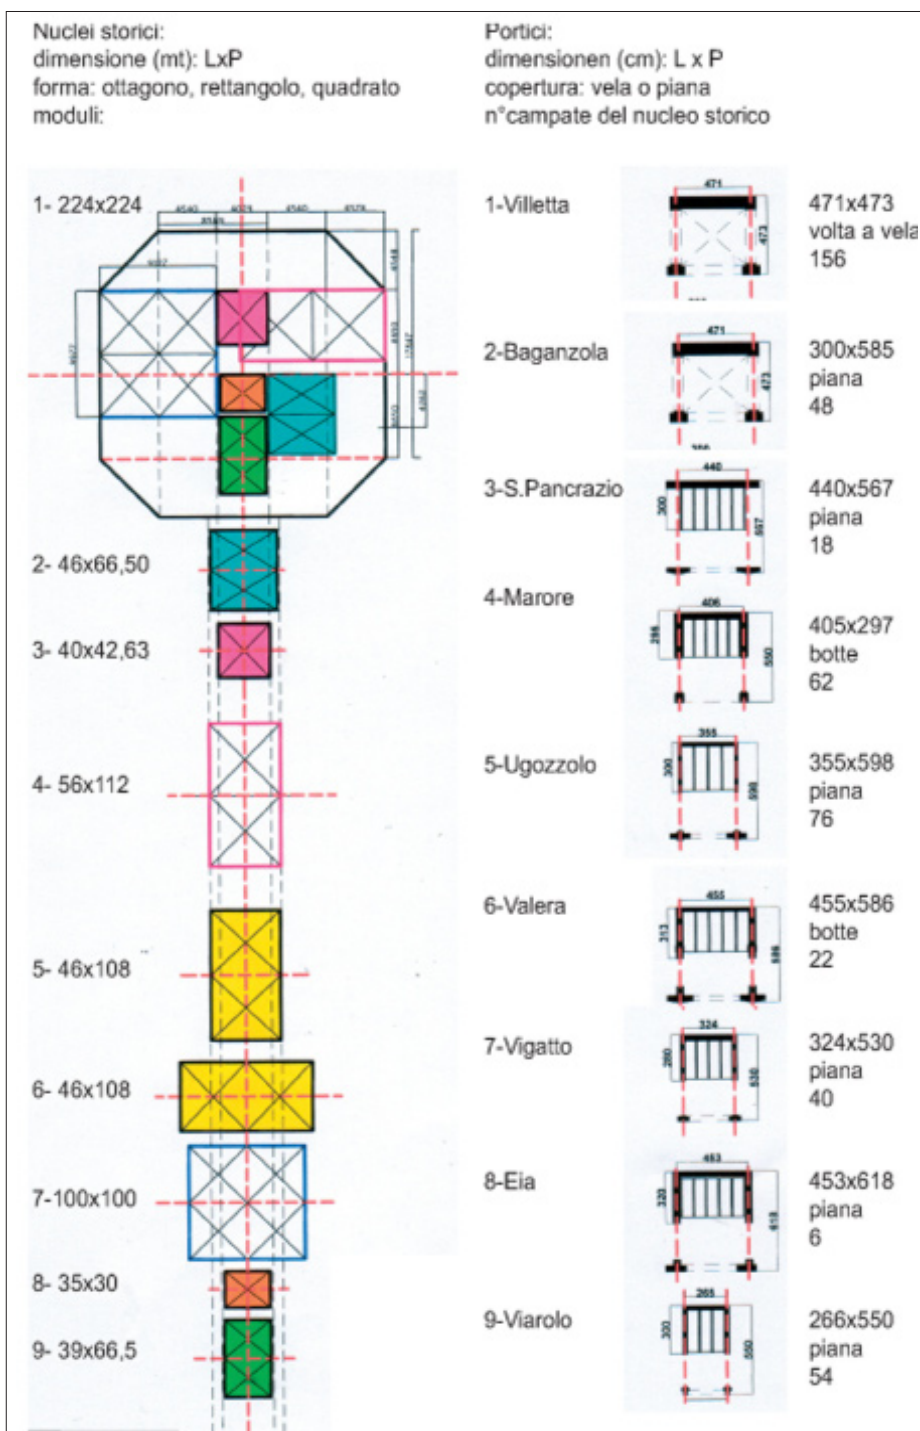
Organizzazione planimetrica dei recinti: forma e dimensione; soluzione planimetrica della campata del portico.
